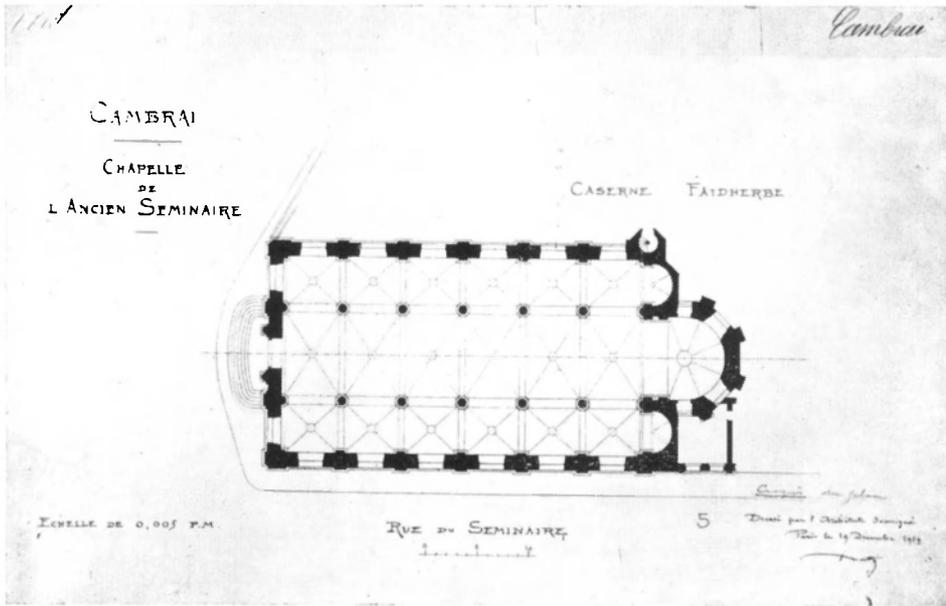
Cambrai. — Plan de la chapelle de l'ancien collège jésuite.
